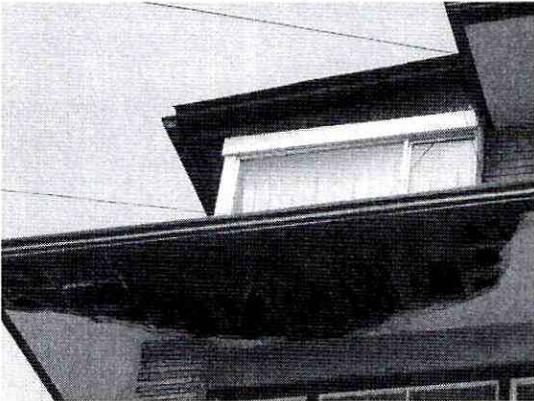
Estado actual de la cubierta en voladizo del tercer piso hacia la parte nor occidental de la edificación. Se observa colapso parcial de elementos de la cubierta conformado por mortero y una malla eslabonada metálica.
